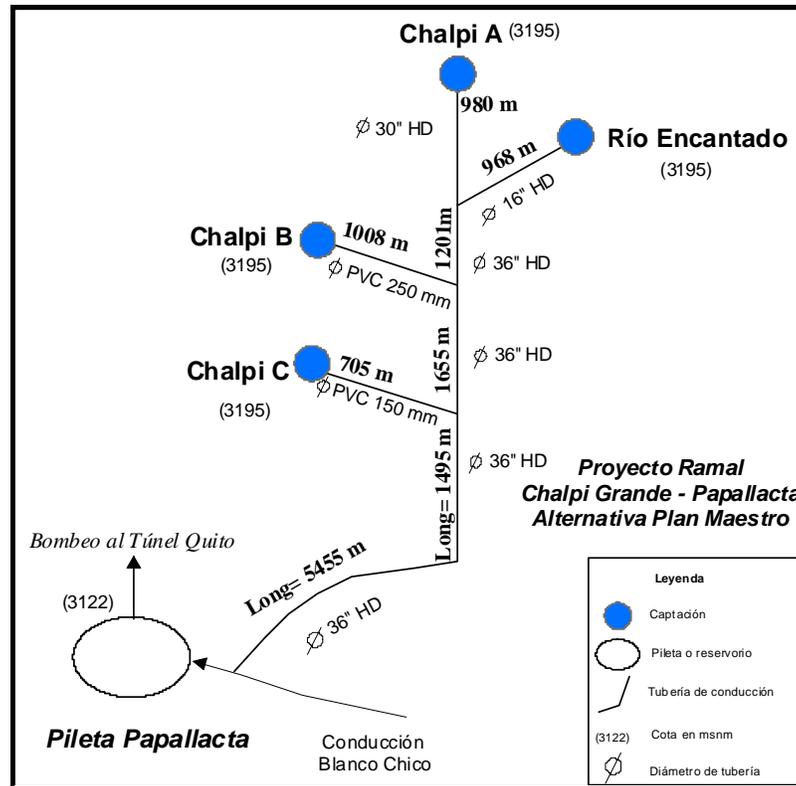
Esquema del Ramal Chalpi Grande – Papallacta, Alternativa Plan Maestro
